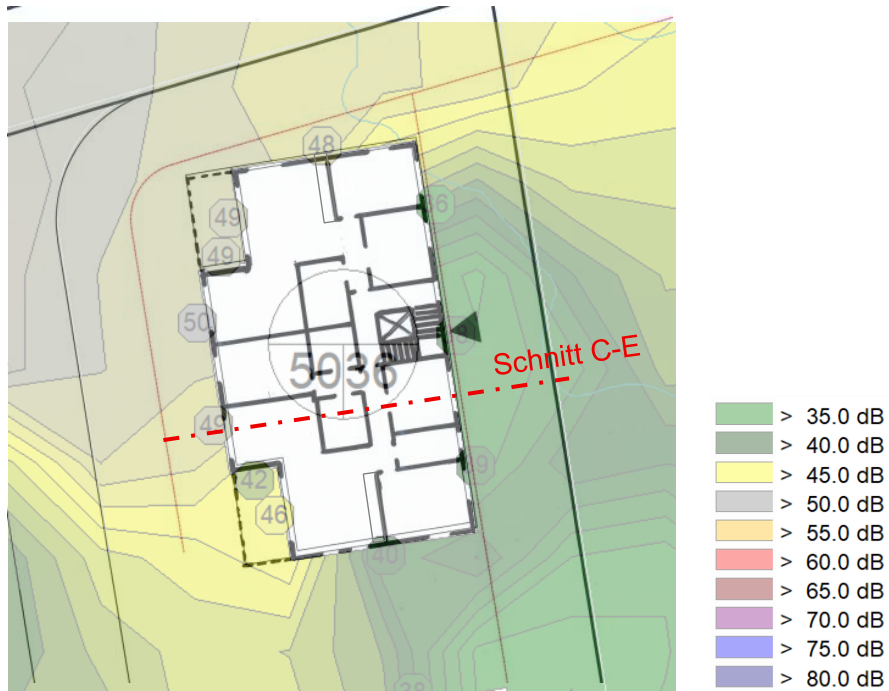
Grundrissoption Gebäude C-E, EG - 2.OG
